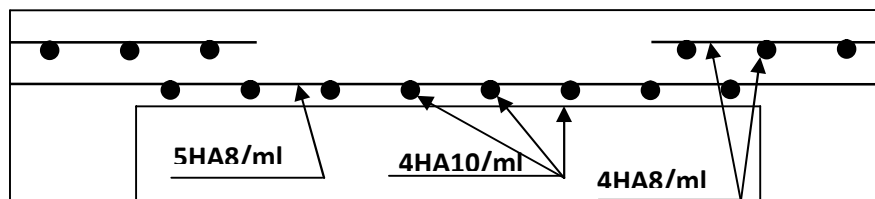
Schéma de ferrailage du troisième type de balcon.
